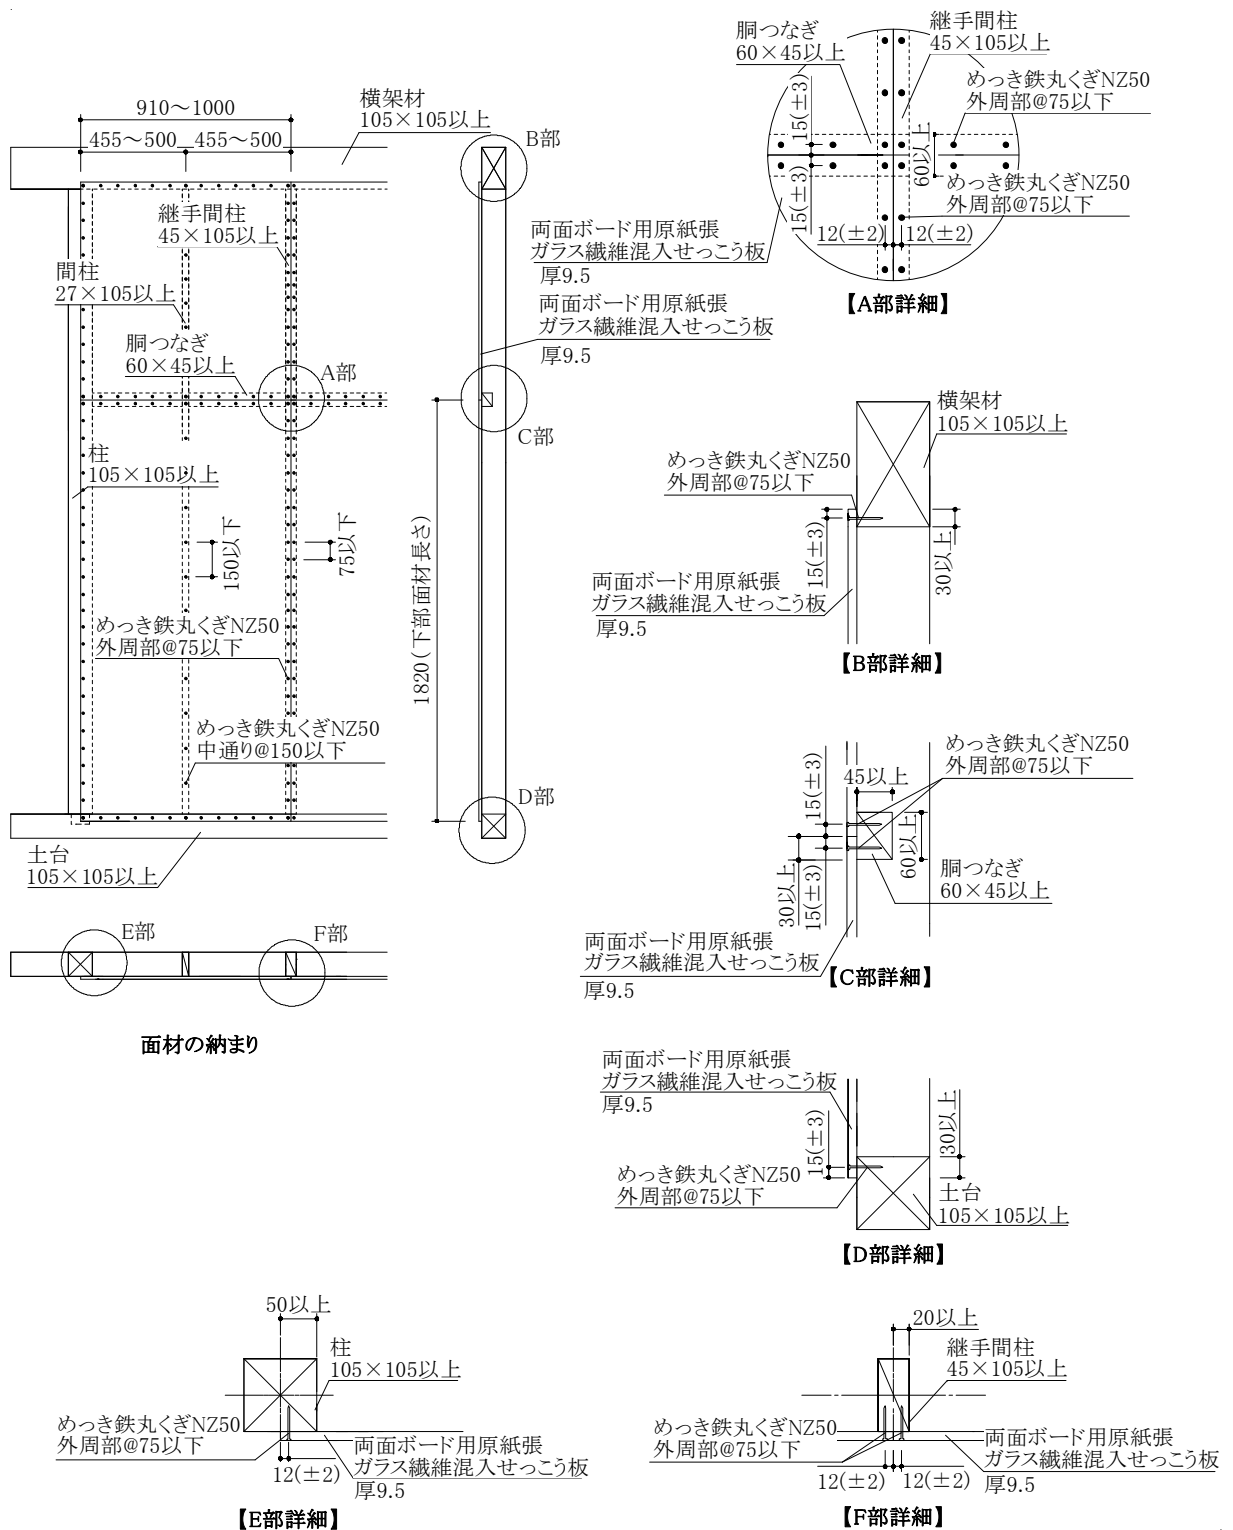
施工図：縦継ぎ張りの場合 (寸法単位：mm)
